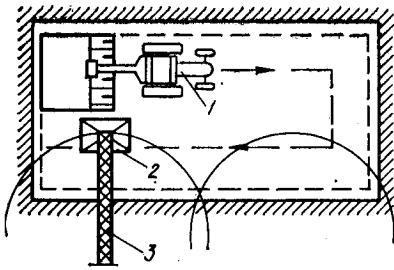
Разработка грунта с использованием экскаватора и крана в особо стесненных условиях:
